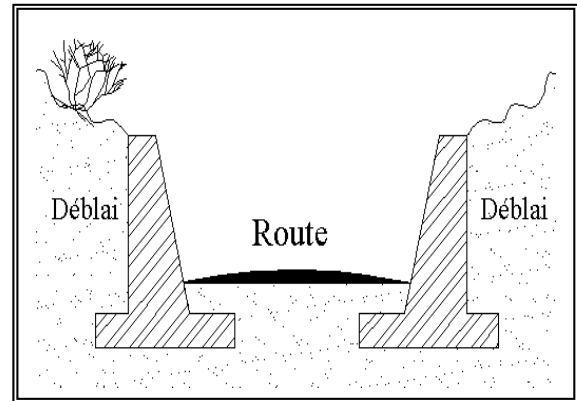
Profil en travers d'une route à travers un déblai - Mur non fixe-
